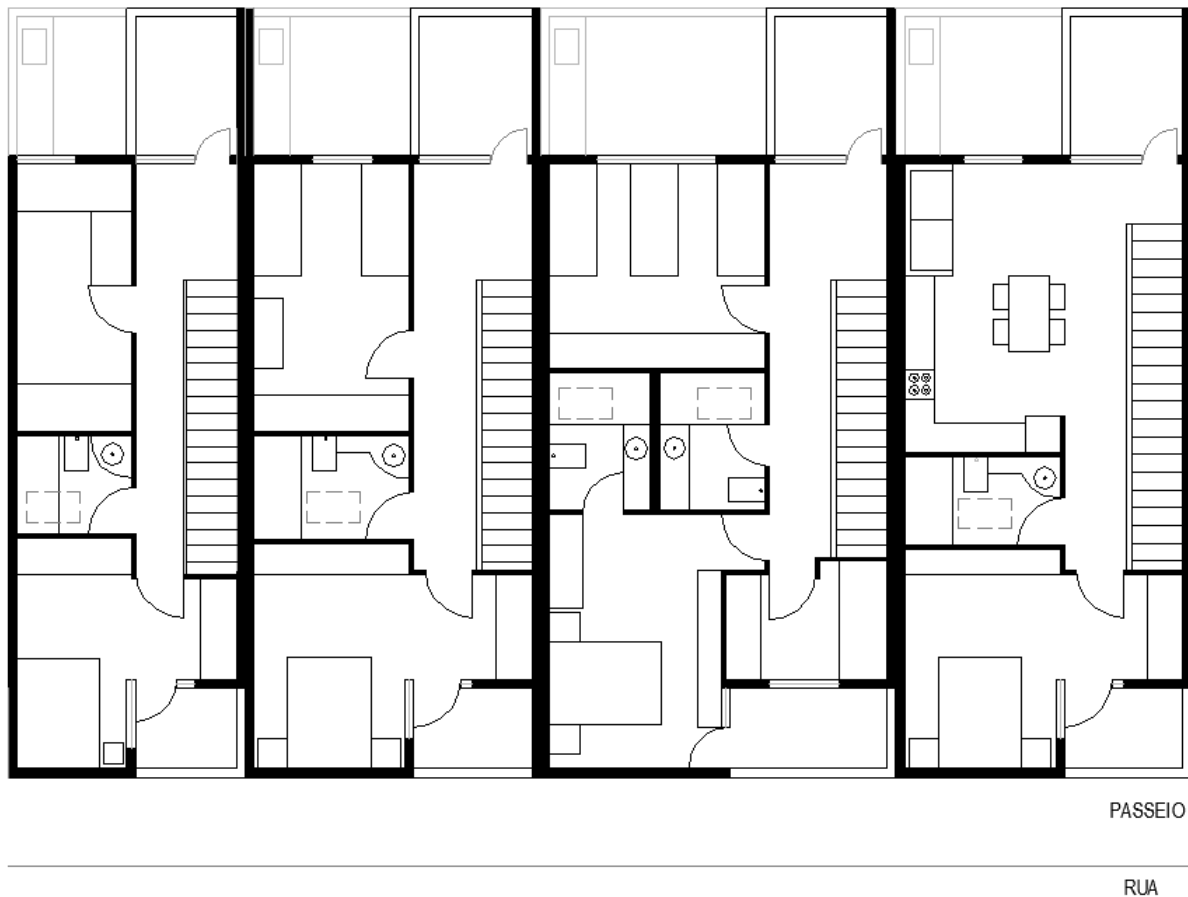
Plantas do piso superior dos tipos de lotes. Fonte: Autor
